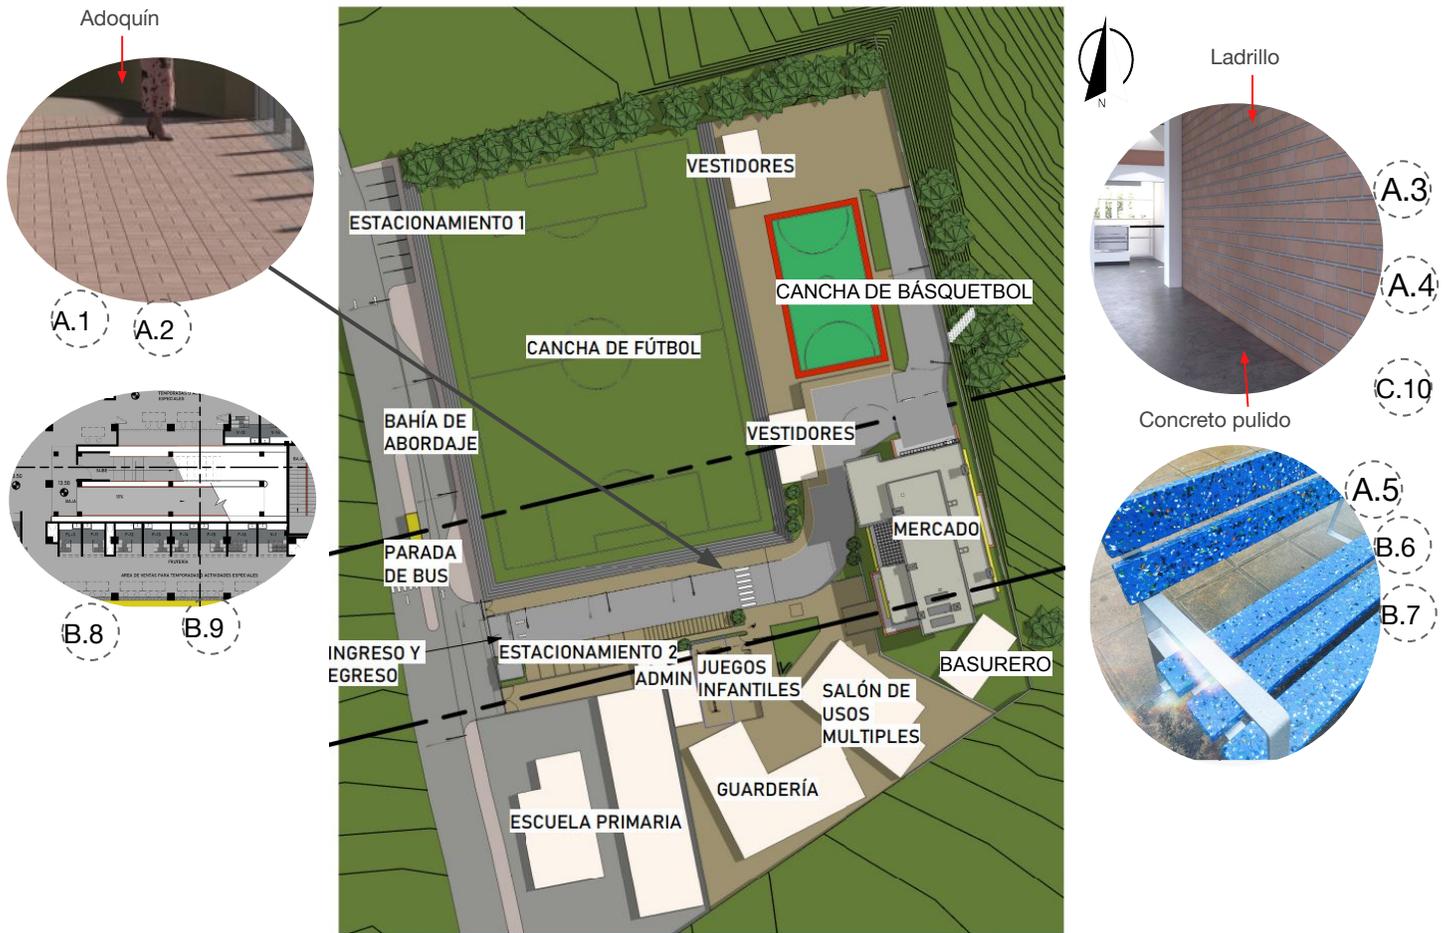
Imagen de materiales de construcción. Fuente: Elaboración propia.
